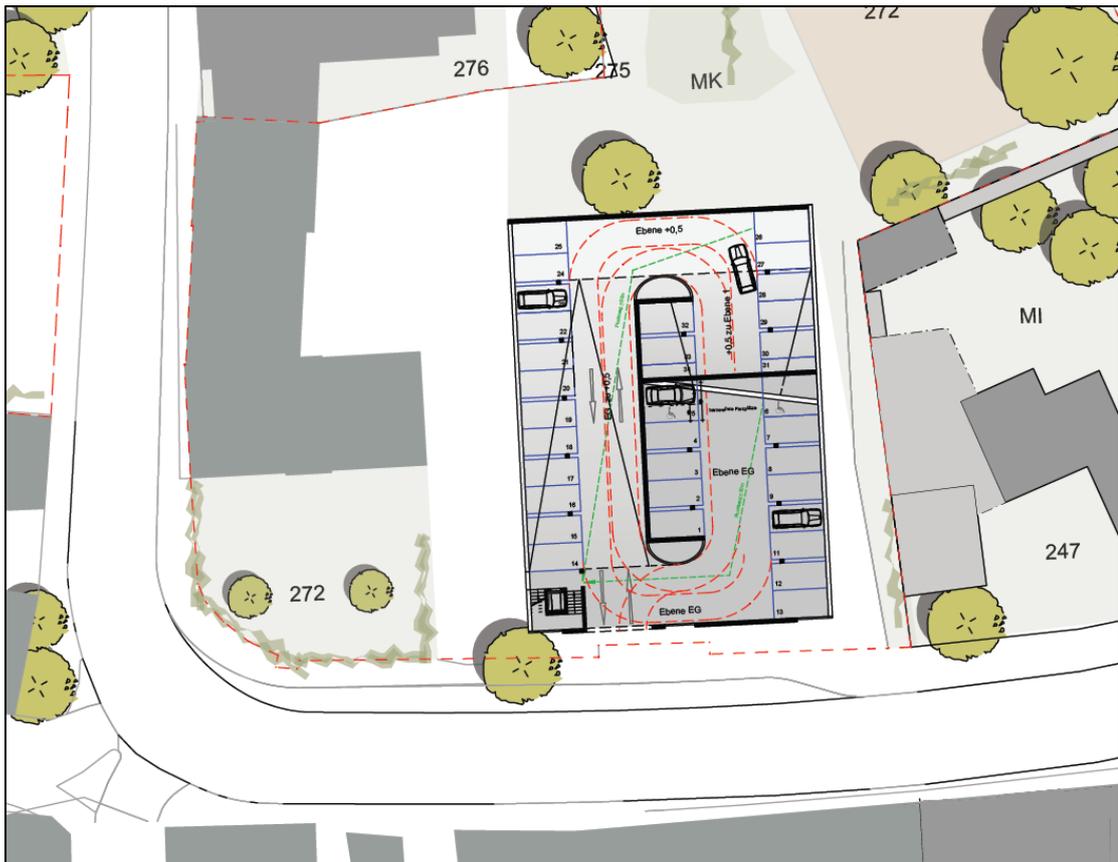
Entwurf Parkhaus Mühlenstraße, Lageplan (Quelle: Machbarkeitsstudie Pfeiffer-Ellermann-Preckel, Stand 03.02.2015)
